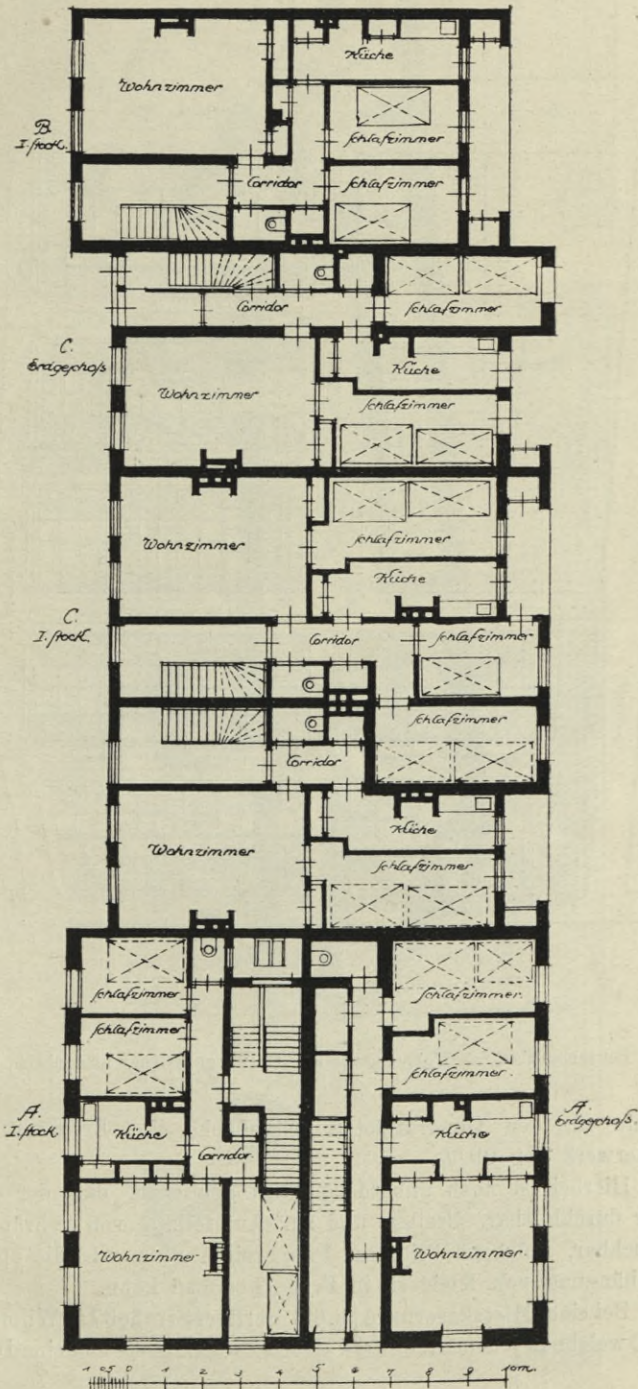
Grundriss zu Abb. 71 u. 72
